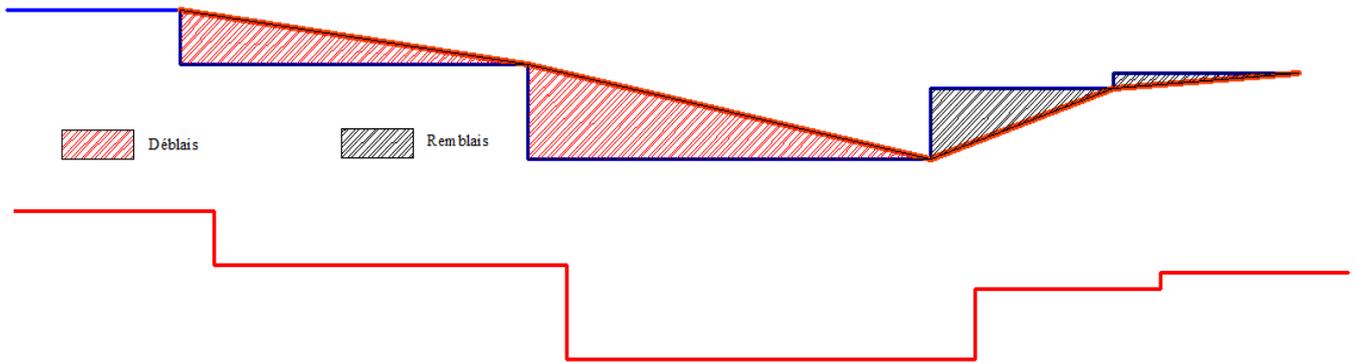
Coupe du terrain d'intervention à la sortie du boulevard projeté
